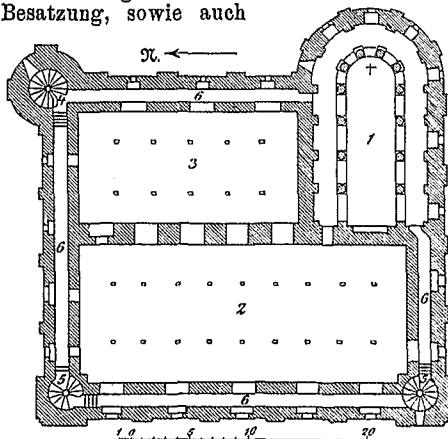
Grundriss vom Hauptgeschoss.
